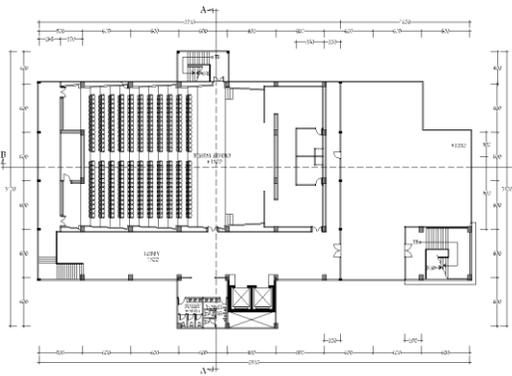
Denah Lantai 1- R. Edukasi Musik, Galeri dan Coffee Shop
